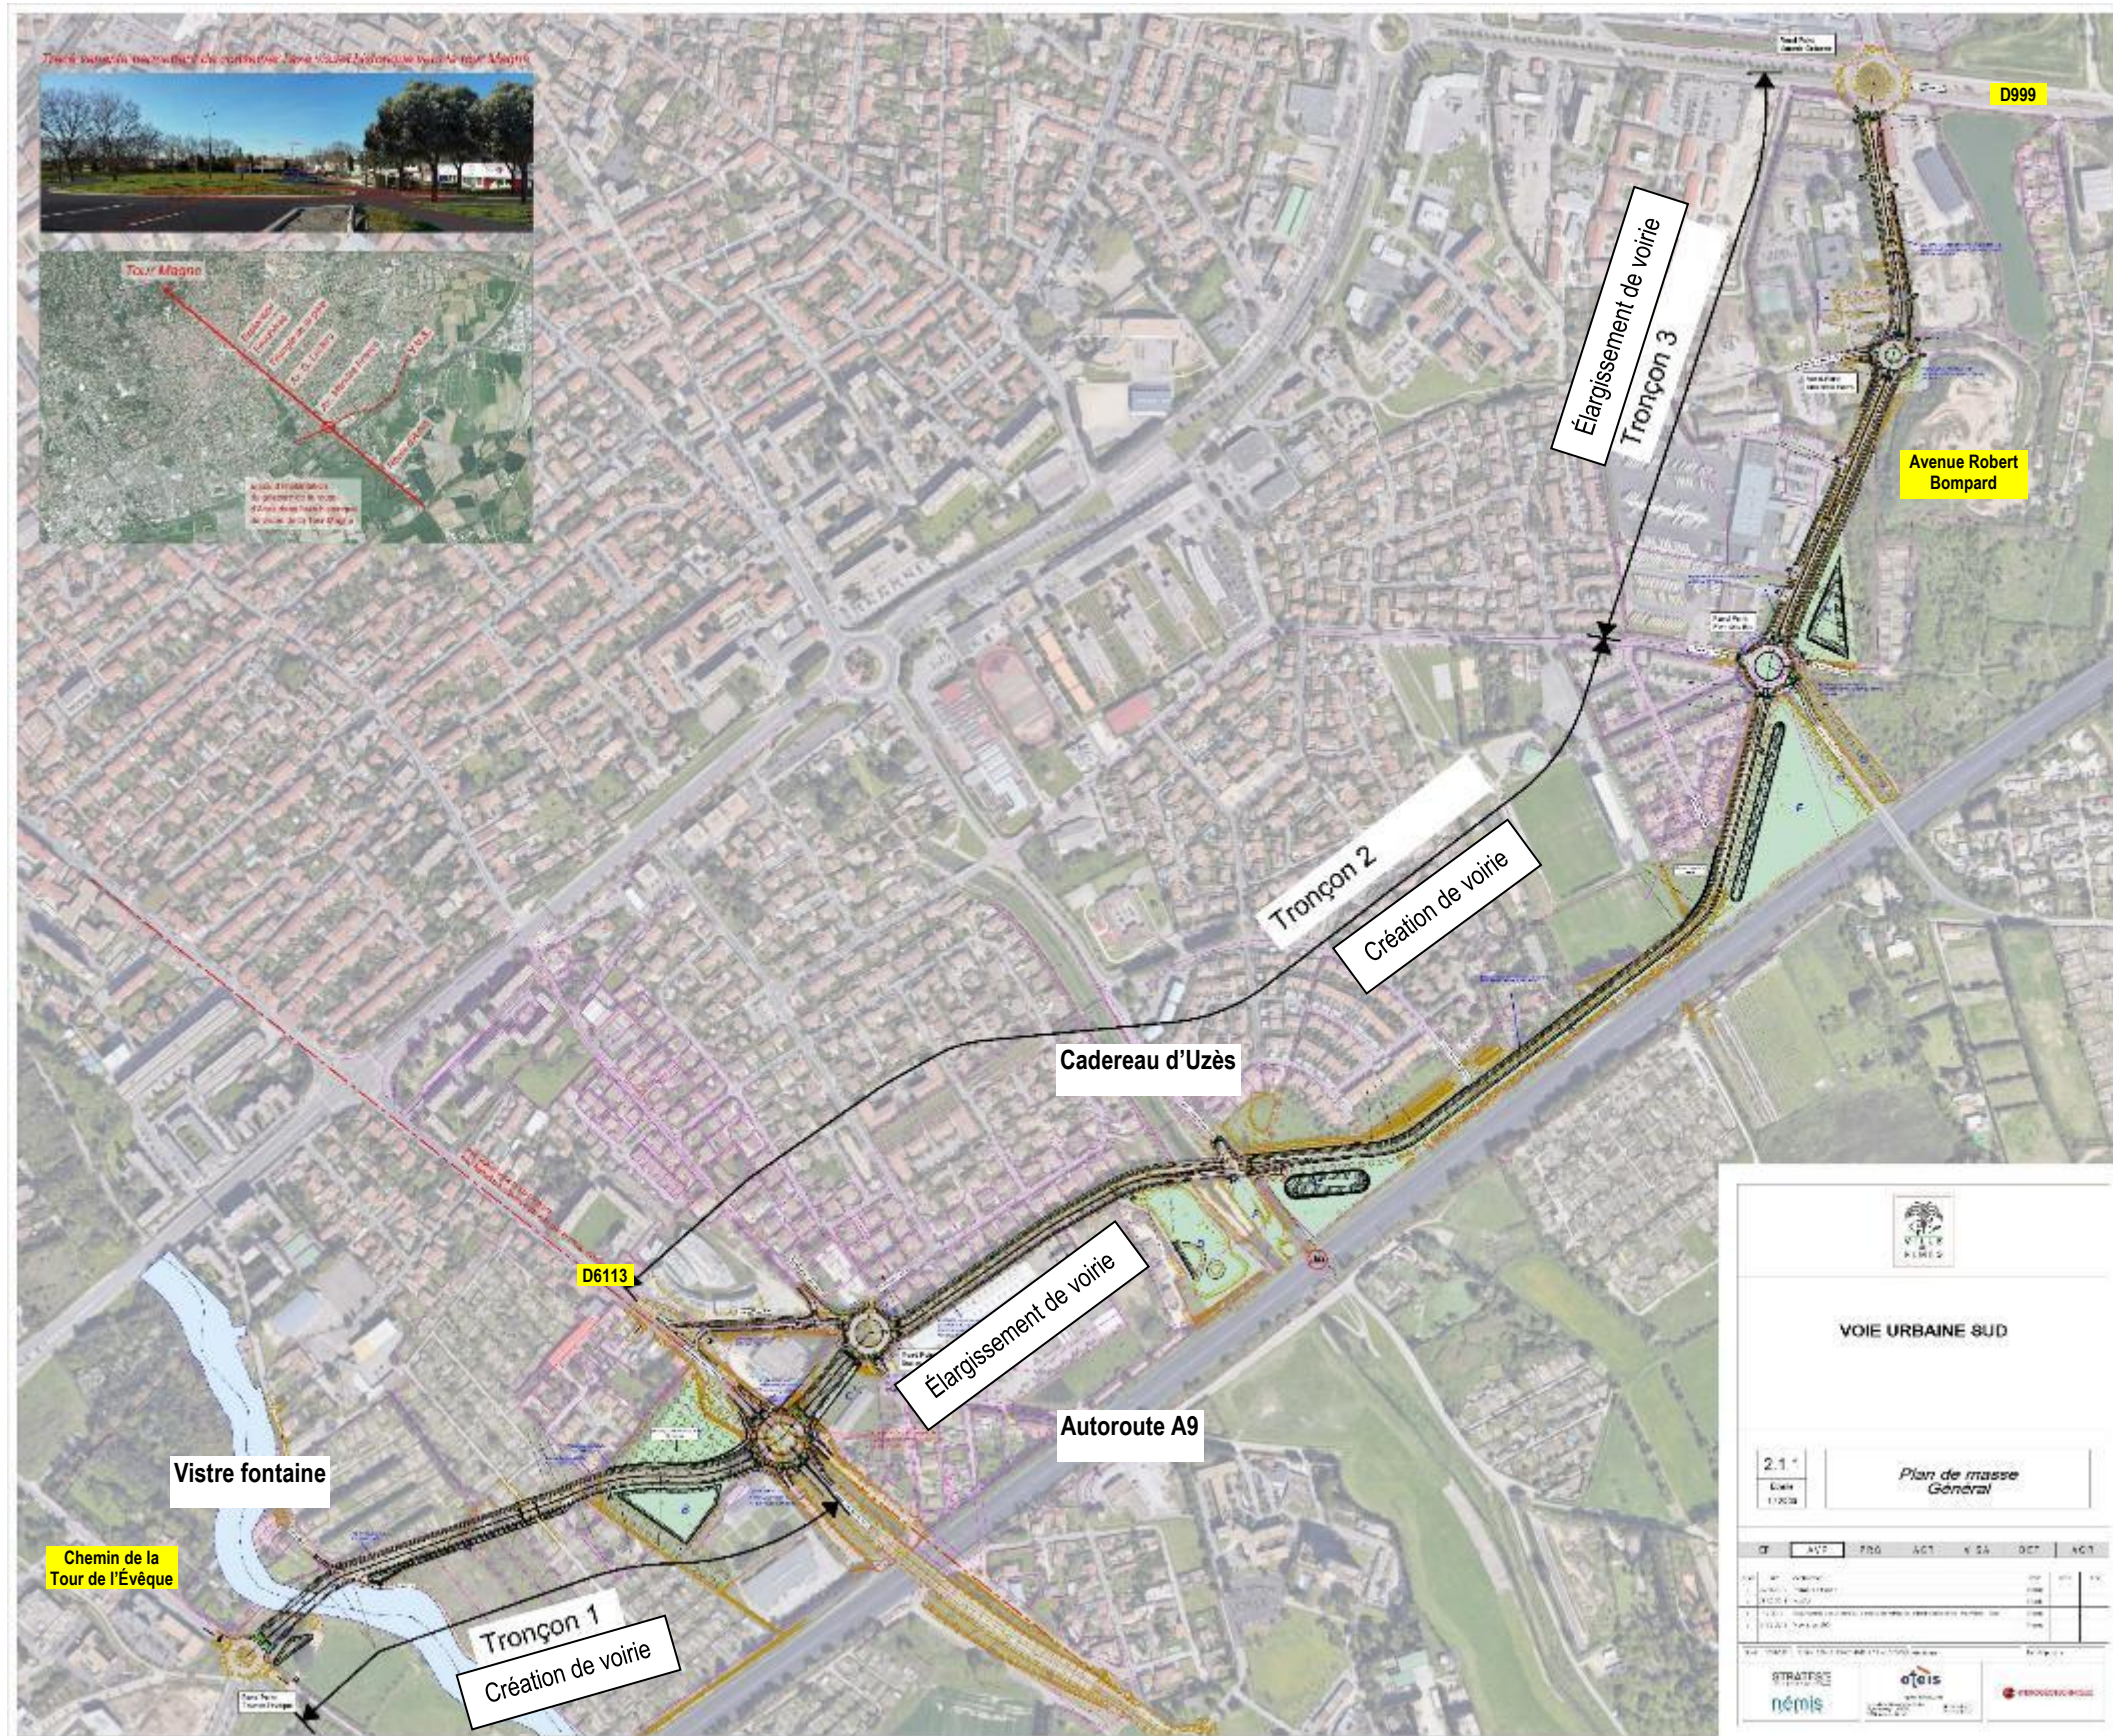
plan de masse du projet d'aménagement - (source : Ville de Nîmes, 04/2019)
